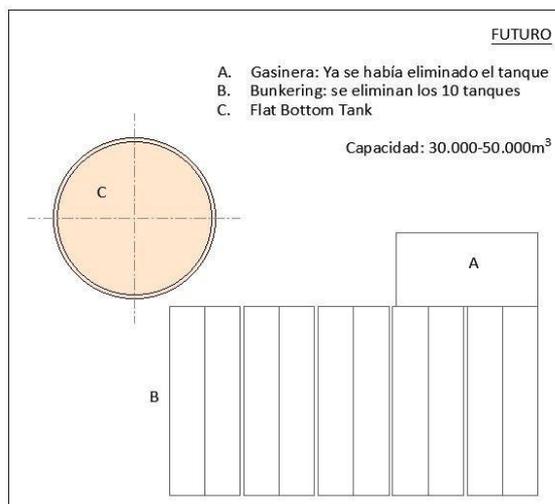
Disposición futura del “Flat Bottom Tank”
